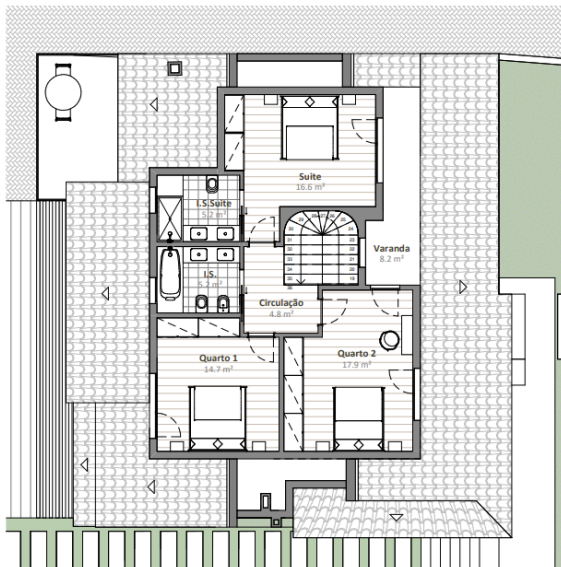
Proposto - Planta do piso 1 (EP_R01). Fonte: Garq / Desenvolvimento: Autora.
